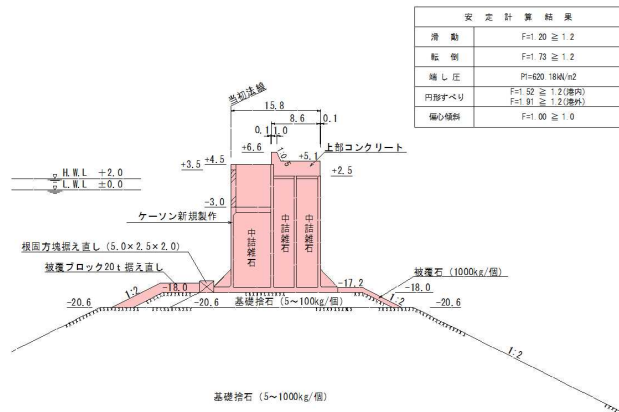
東側延伸部（ケーソンNo.3）の復旧断面図
